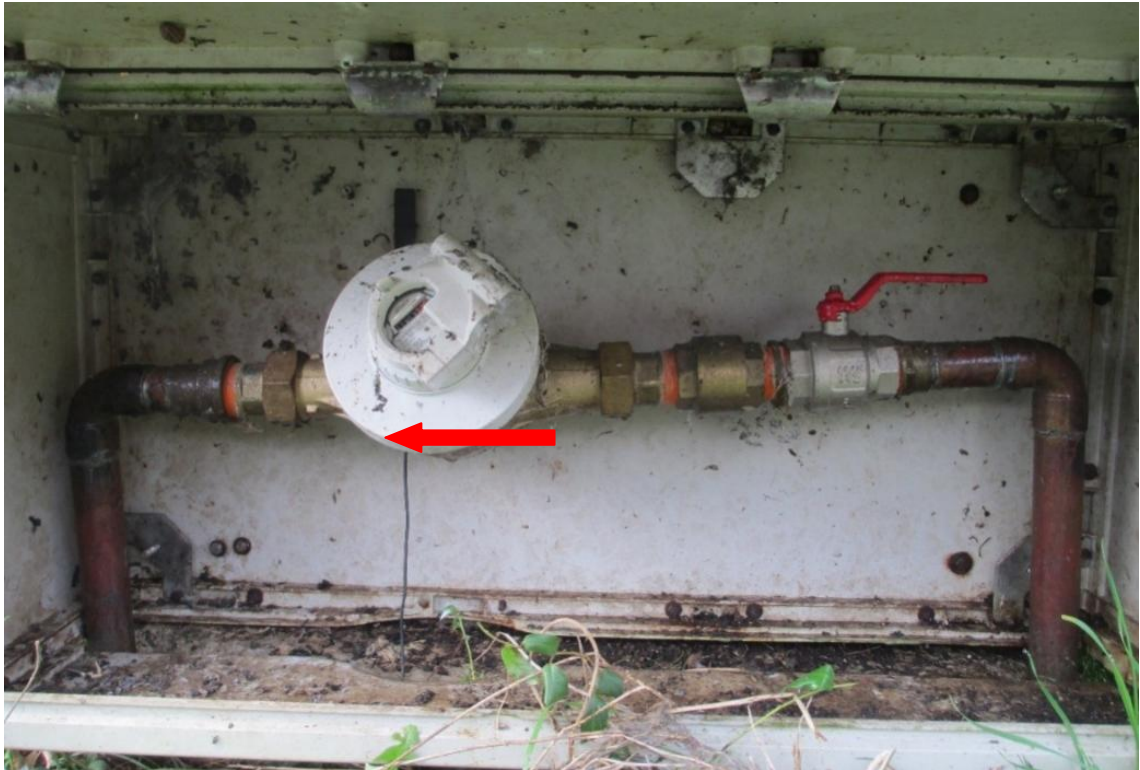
Foto de la instalación original del contador en M900 (EDAR), B.
